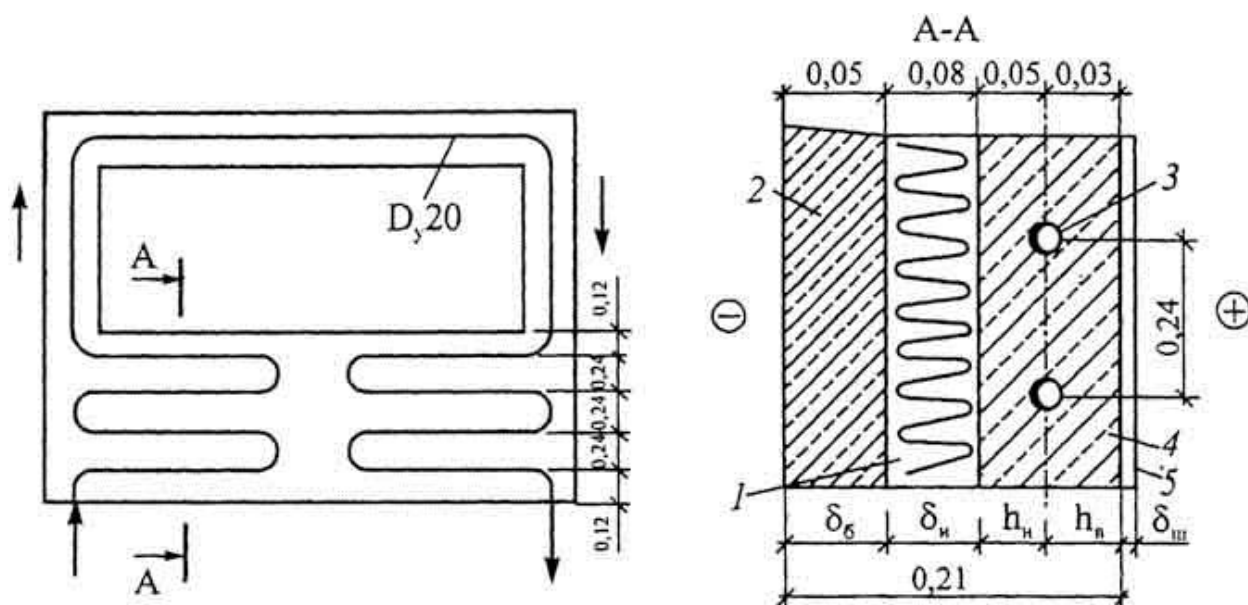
Бифилярный стояк системы водяного отопления с греющими элементами змеевиковой формы, совмещенные с трехслойной наружной стеновой панелью: 1 -тепловая изоляция; 2 - наружный железобетонный слой; 3 - греющая труба; 4 - внутренний железобетонный слой; 5 - штукатурка
